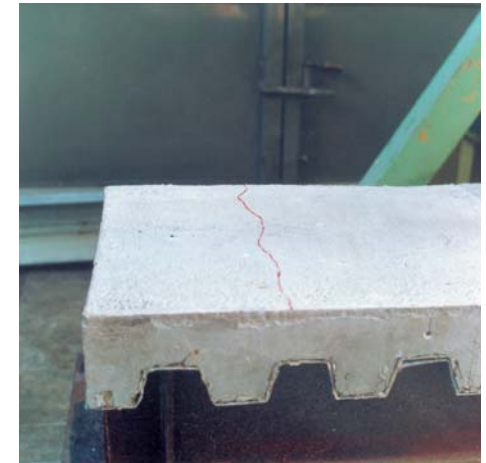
Échantillon t2 après l'affaissement de la poutre en acier : détail de l'appui 35
